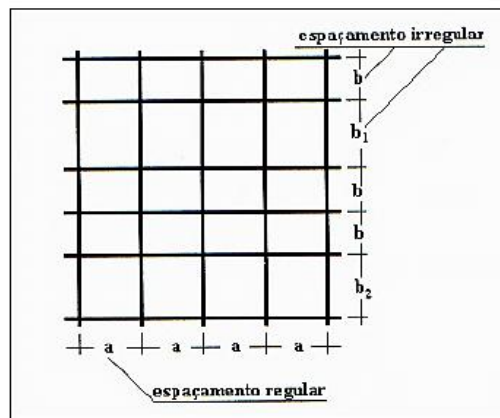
Espaçamento irregular em armaduras de lajes
